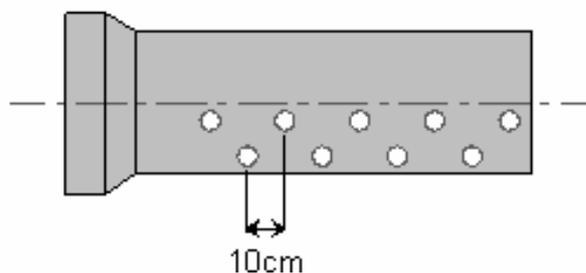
7 PERFORACIÓN EN TUBERÍAS
